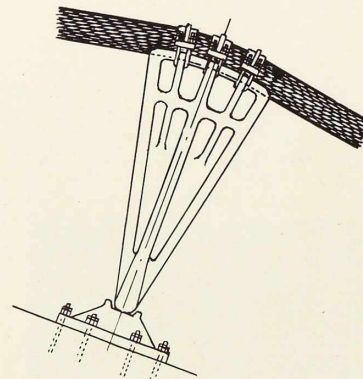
et 3. Détail de suspente et béquille d'infléchissement des câbles sur culée.
